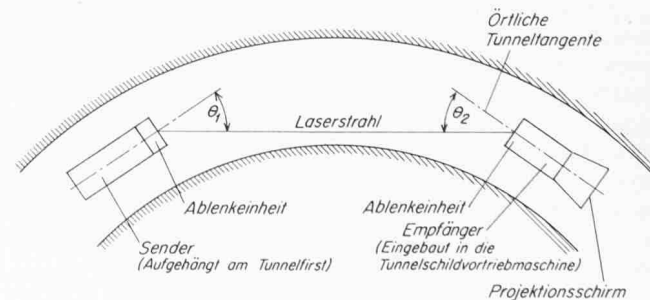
Einrichtung zum Auffahren von Bögen im Tunnelbau (schematisch, nach Bölkow)
